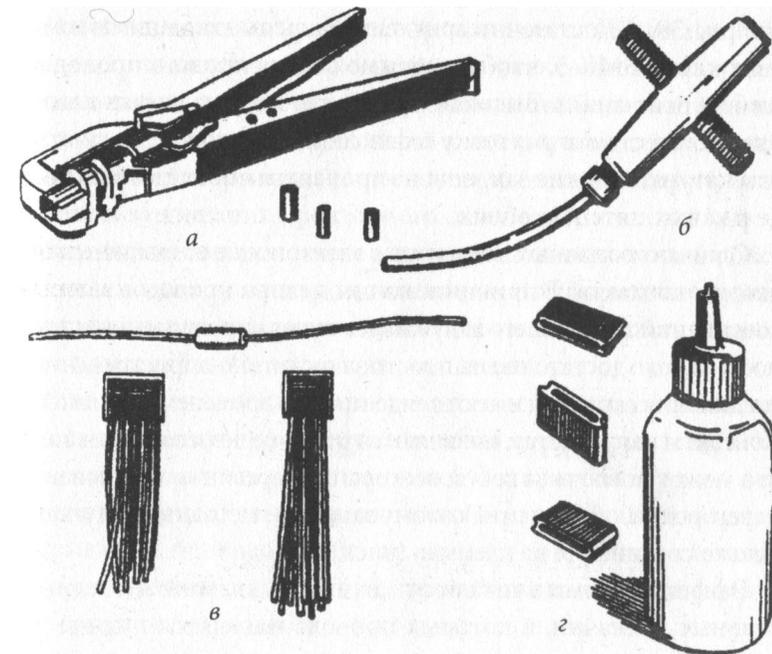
Соединительные приспособления: *а* — пресс-клещи ПК-3 и гильзы ГАО; *б* — соединительные клеммы «Wago»; *в* — пластиковые соединители СПЭП и специальный ключ для сращивания проводов; *г* — пластиковые пластины-закрепы ПК, прикрепляемые к стене клеем БМК-5
